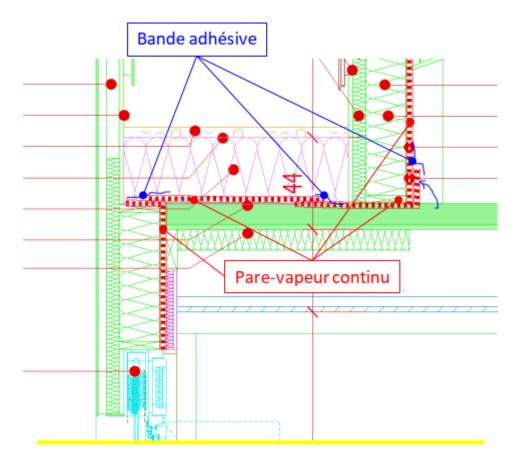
Etanchéité du collège, détails parois rez-de-chaussée et R+1
